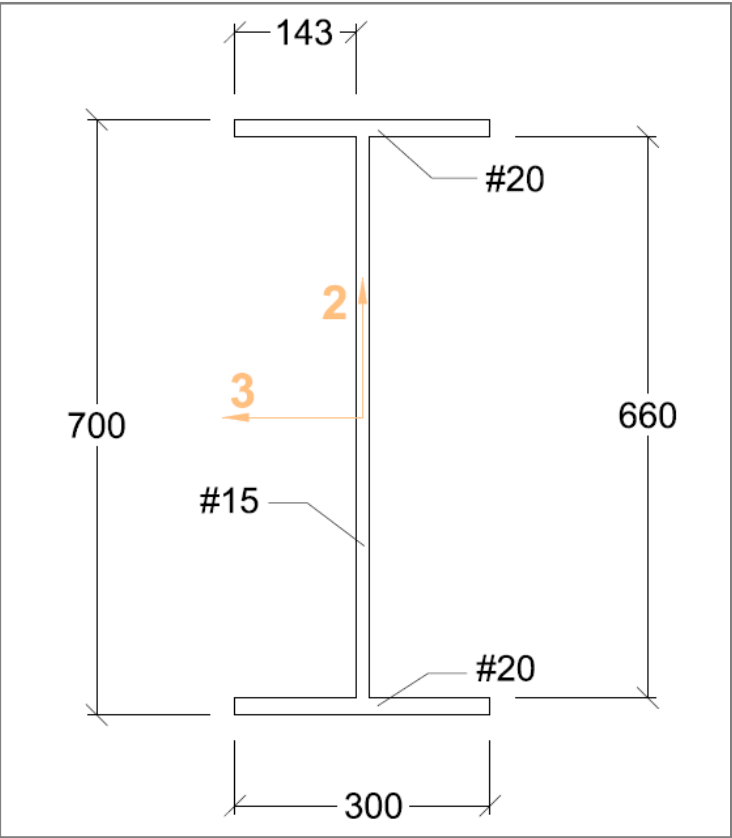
Sección vigas de piso en empotramiento de voladizos (cotas en mm).
